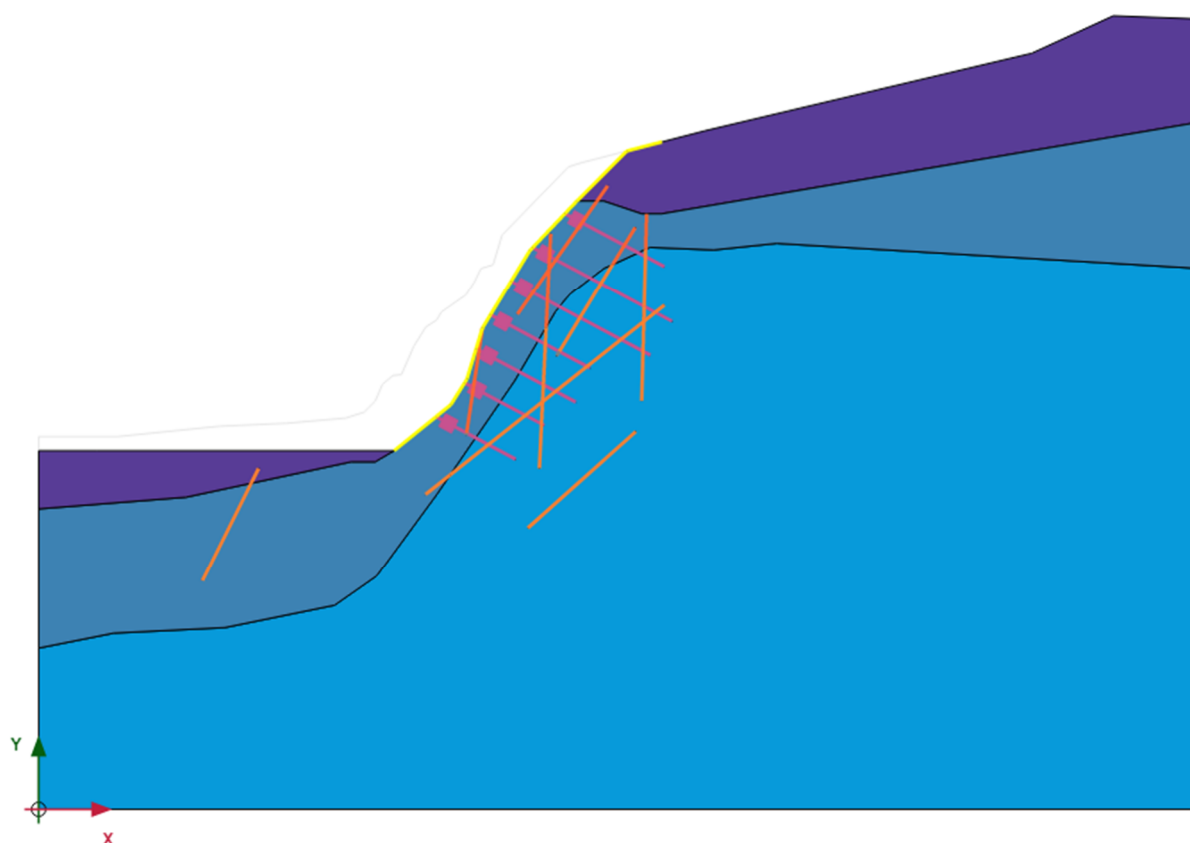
Řez B-B' stabilita upraveného svahu
